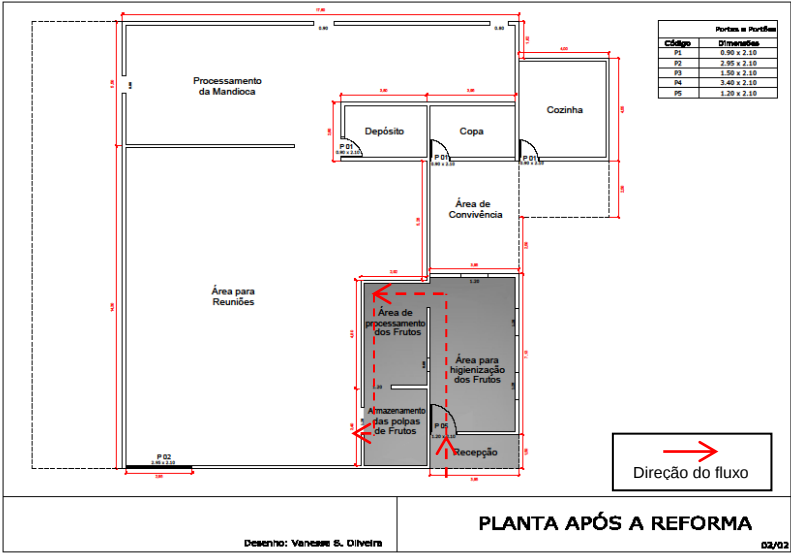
Planta baixa da área de processamento de polpas de frutas na ARQP após a realização das adequações estruturais, ARQP, 2015.
